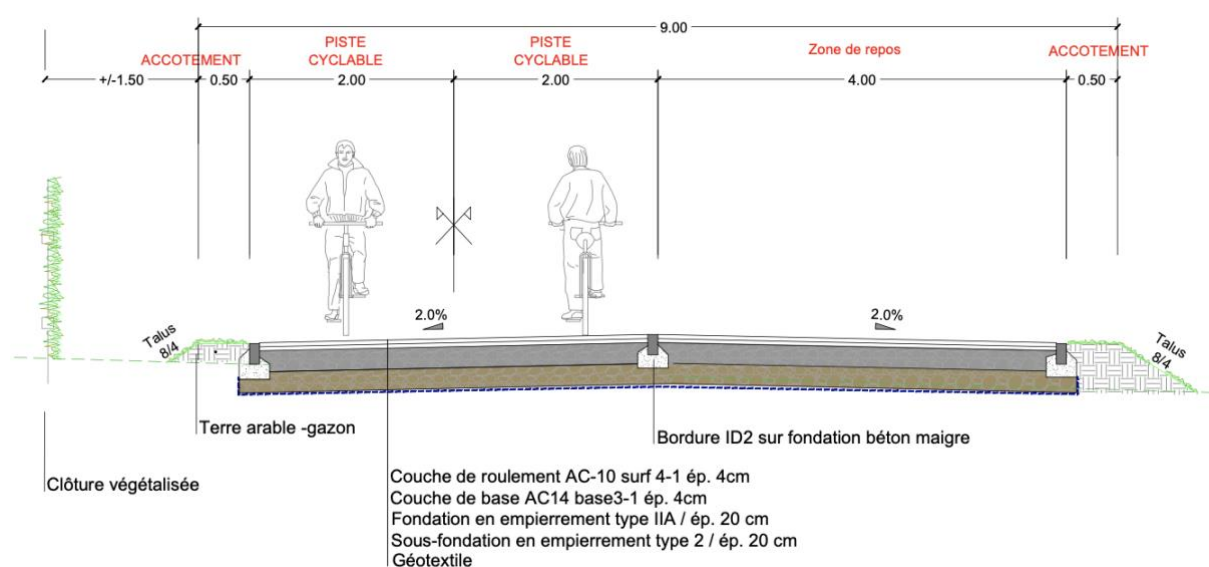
Coupe de la future cyclostrade (SPW, 2023).
